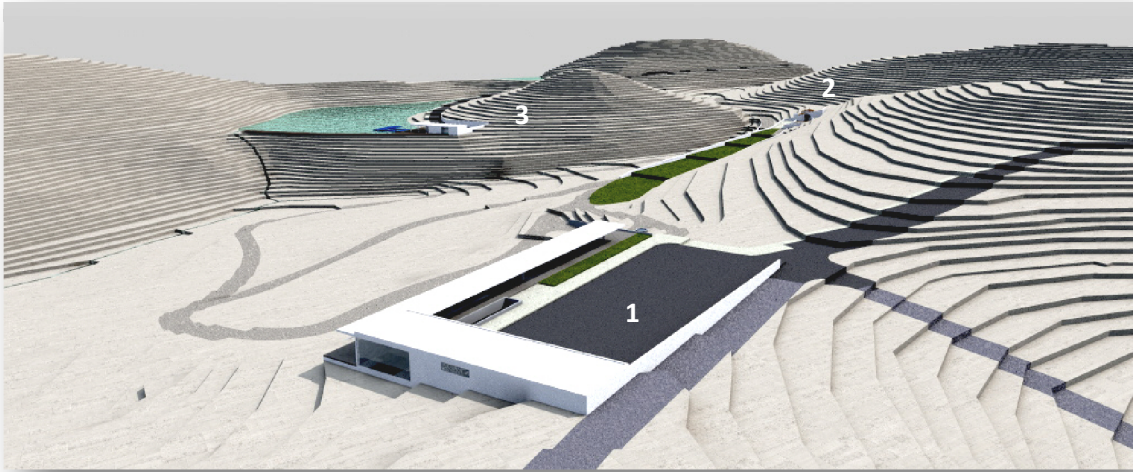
Vista geral da proposta de intervenção; 1 – Pousada; 2 – Ermida de Nª Sª do Paraíso; 3 – Zona de apoio à barragem.
